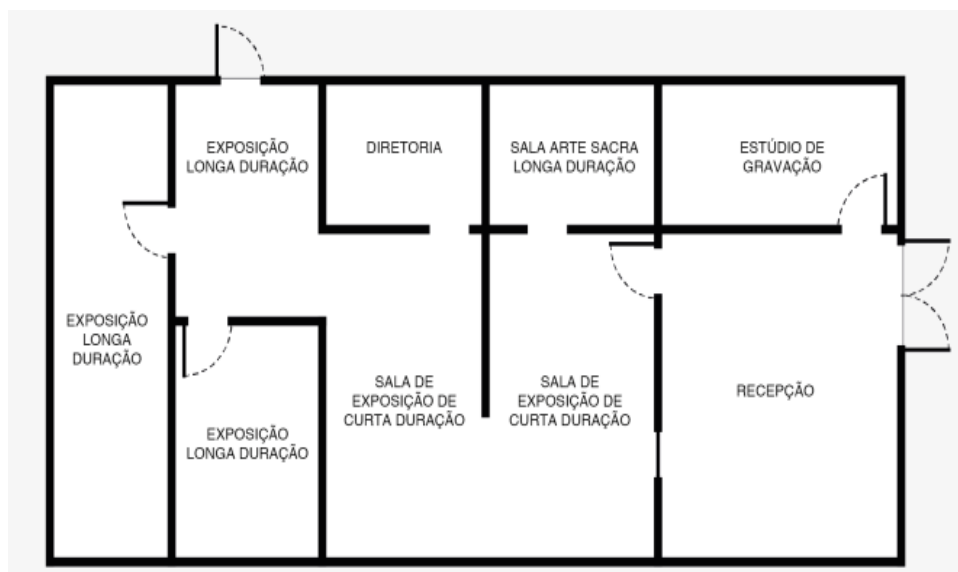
Planta baixa do Museu do Vaqueiro. Diagnóstico Preliminar. Arquiteta: Pamela Franco
